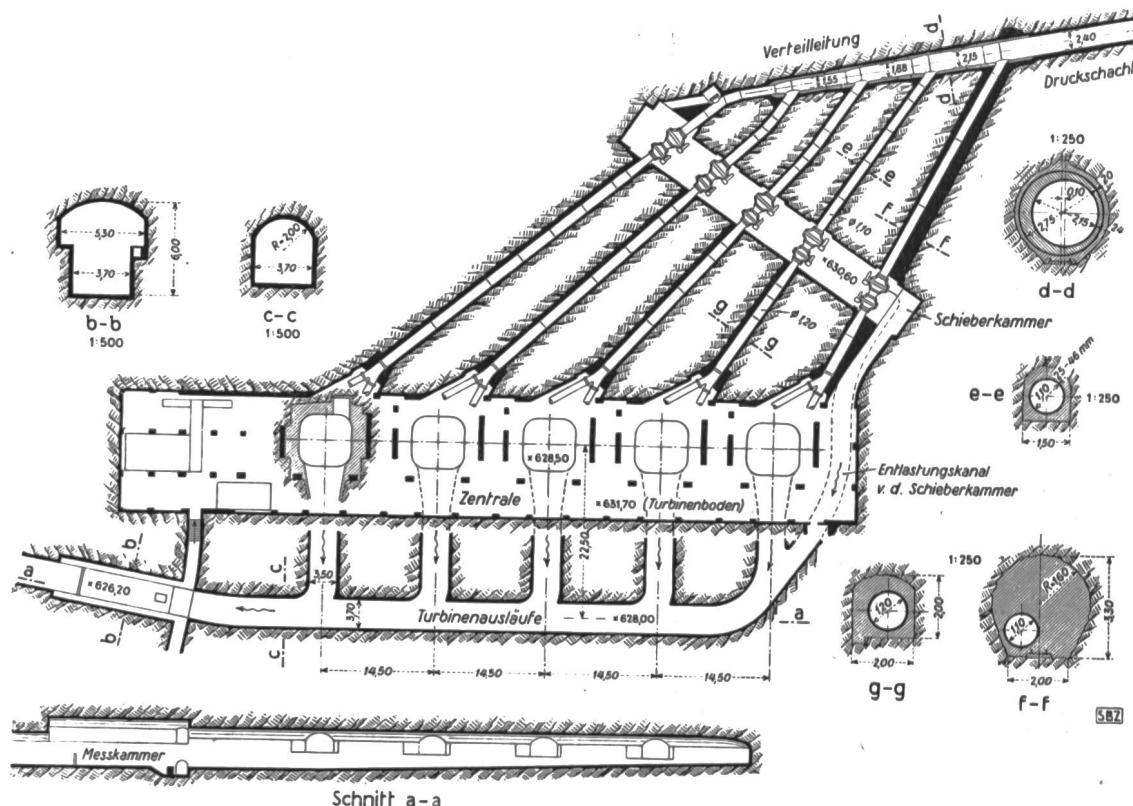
Verteilleitung, Zentrale und Turbinenausläufe; Grundriss 1:1000 und Schnitte.
